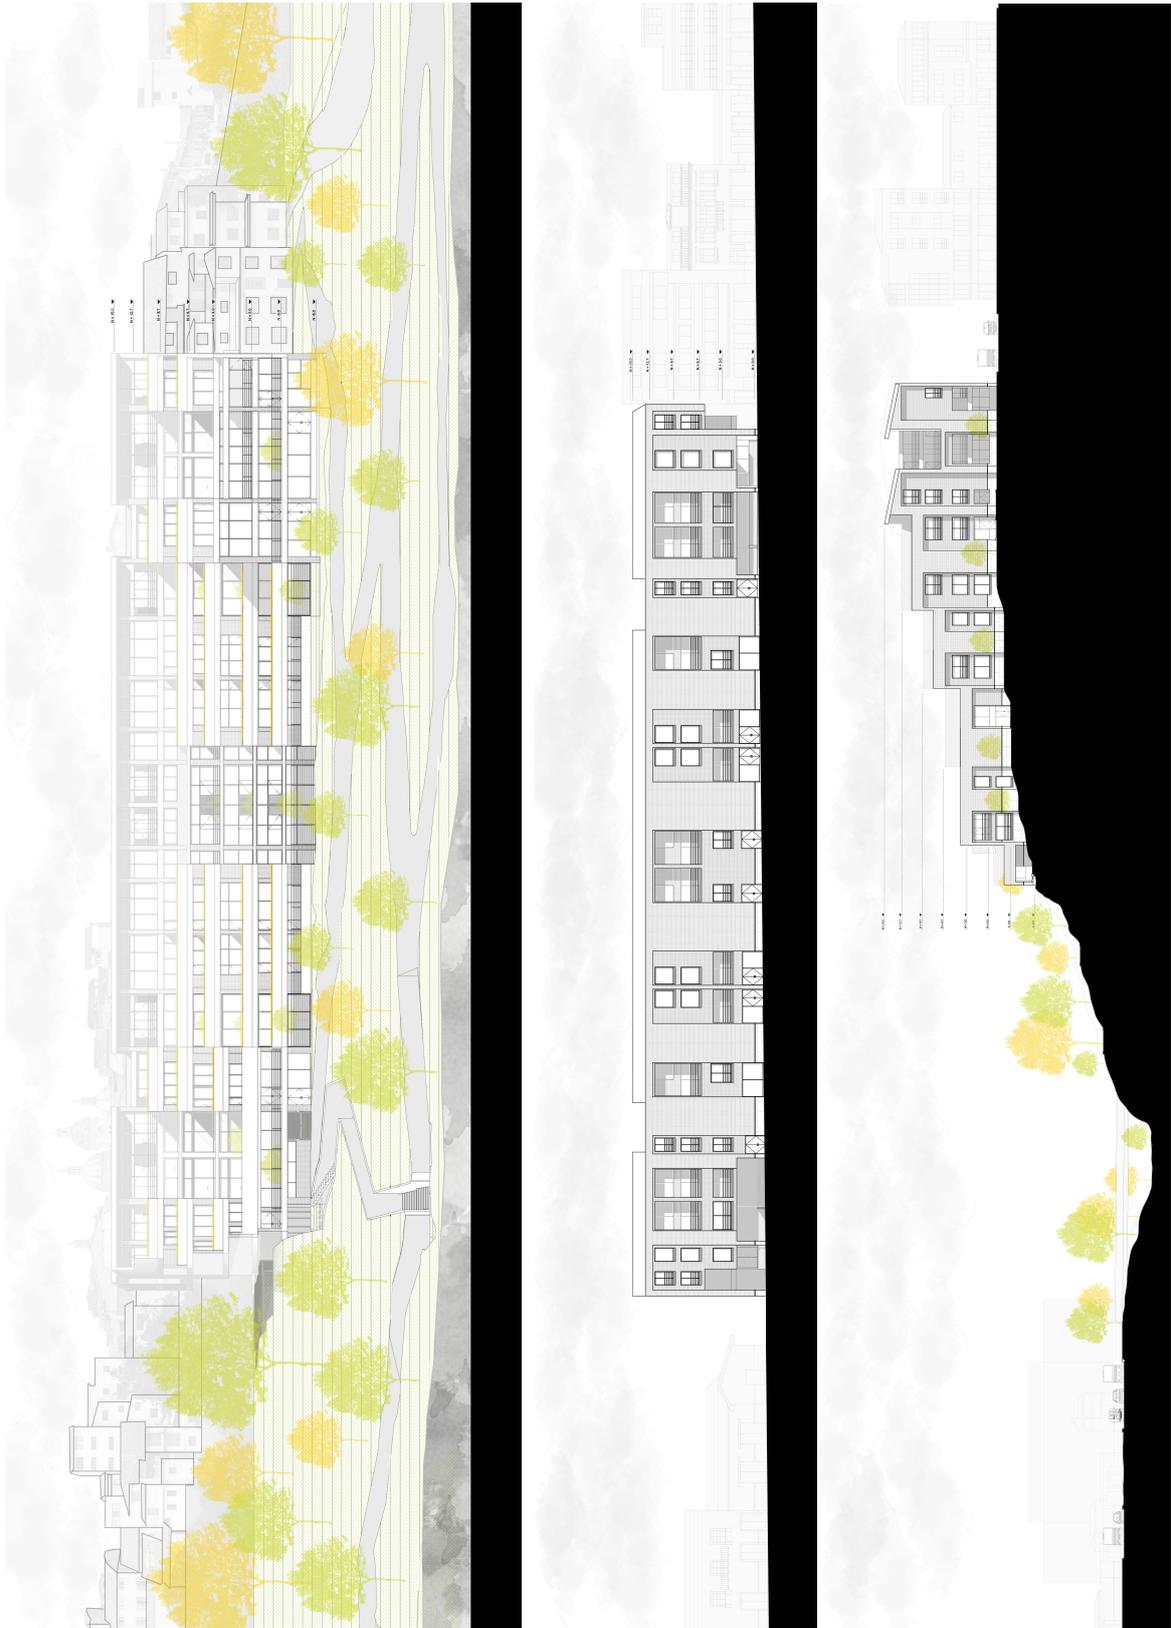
Fachadas Posterior, Frontal y Lateral (Elab. Propia)
